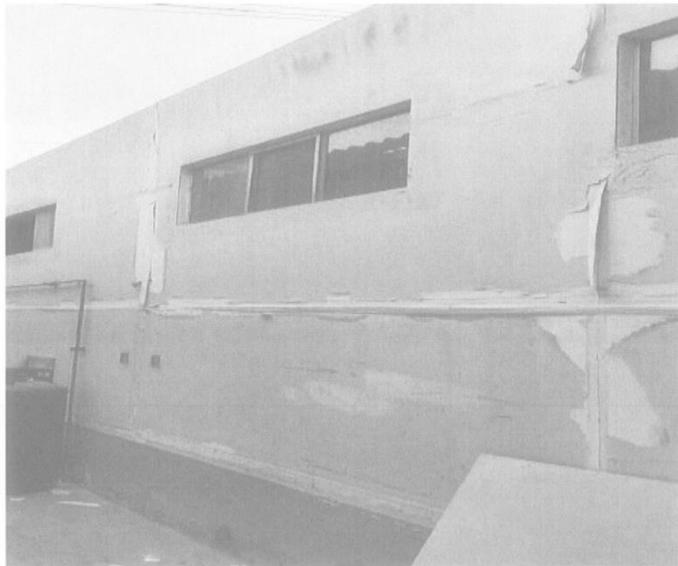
Muros de drywall en mal estado, ausencia de cobertura
